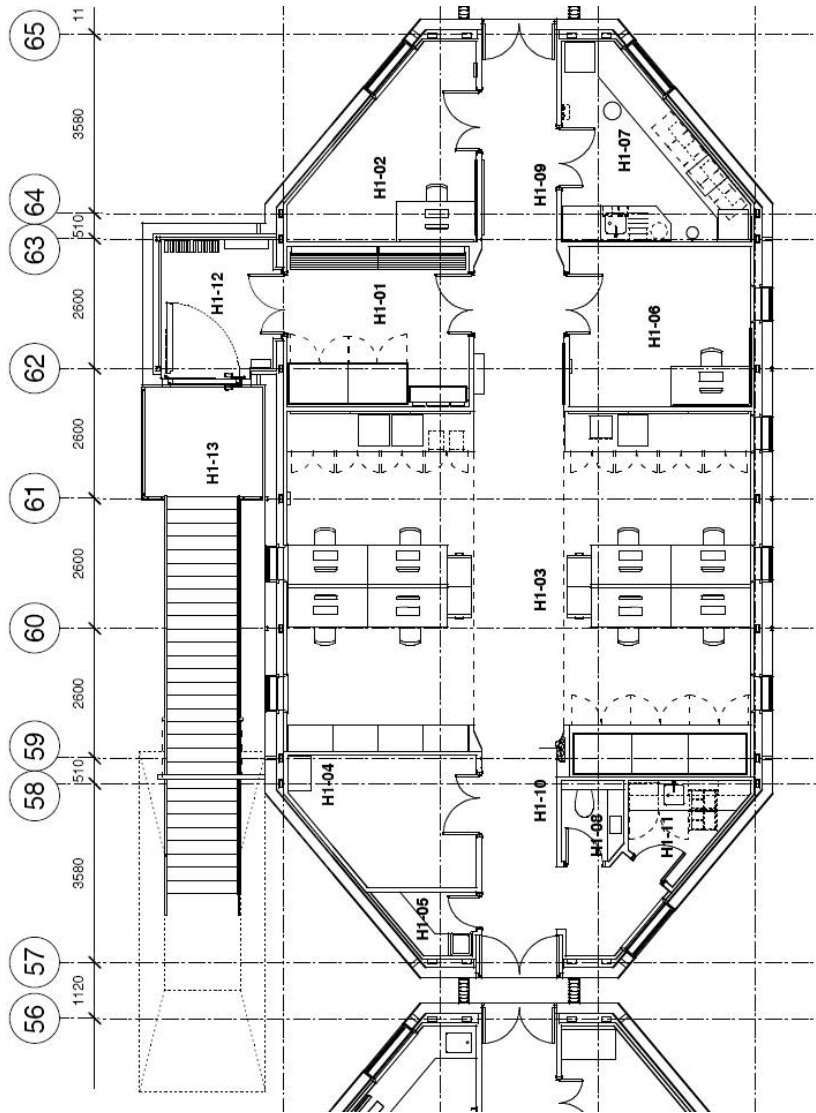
| GRUNDRISS FORSCHUNGSMODUL H1, EINGANG, LABORE UND BÜROS, 180 m²
